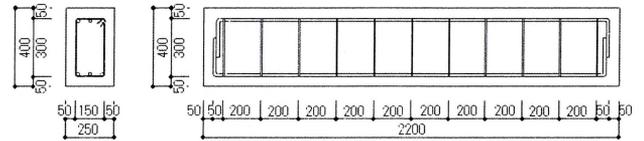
ひび割れを発生させた鉄筋コンクリート梁
